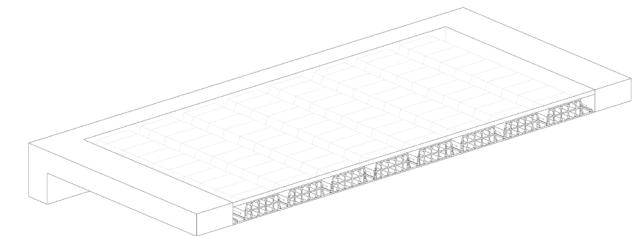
Vista assometrica del solaio in laterocemento; Fonte: elaborazione personale;
